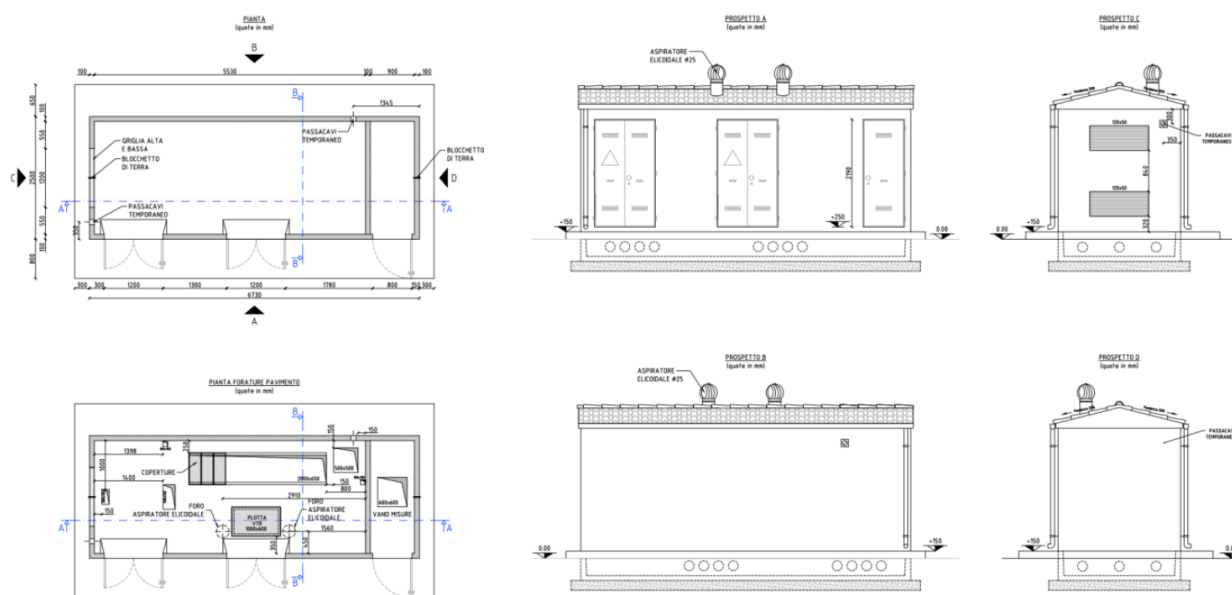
Pianta e prospetti del locale dedicato al Gestore di rete
